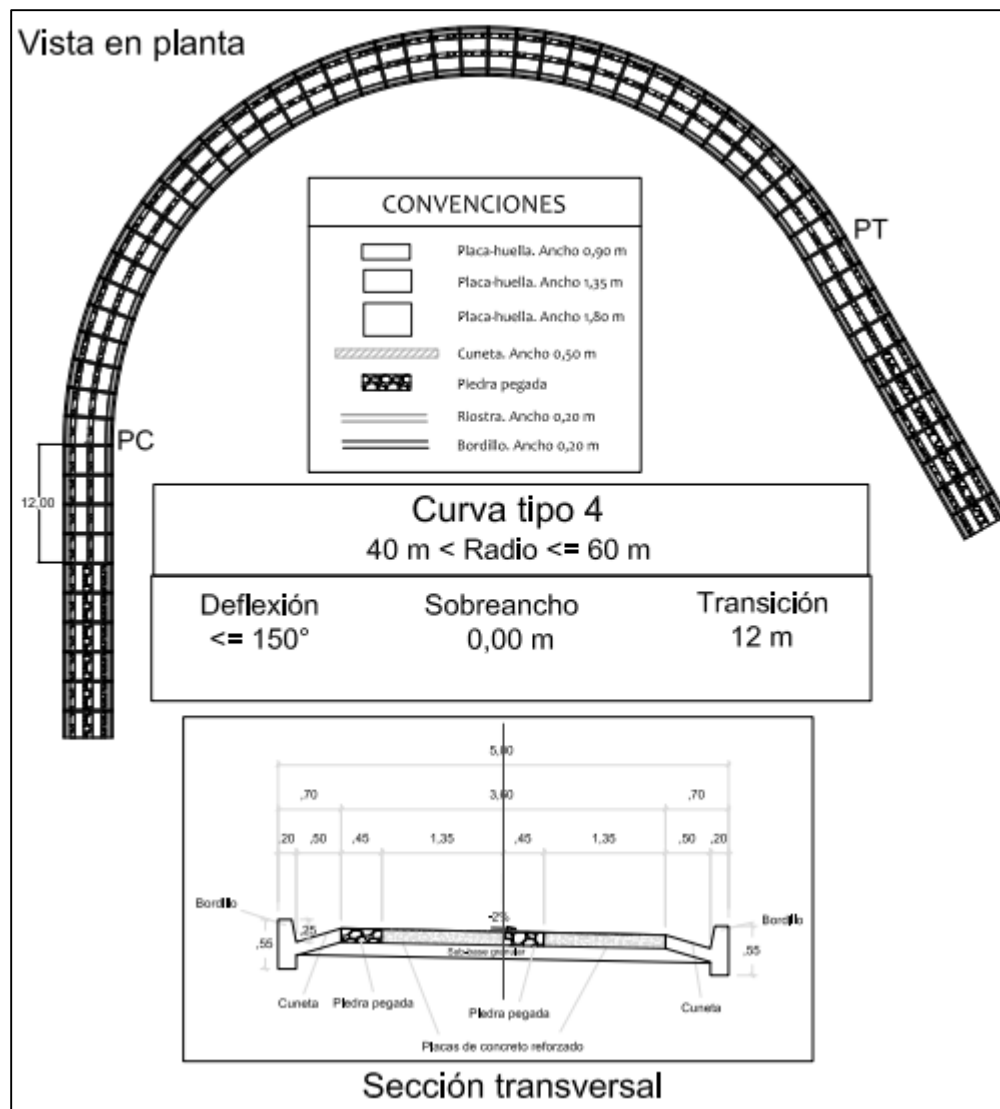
Diseño estructural con corte trasversal y vista en planta para el décimo tramo, curva 5.
